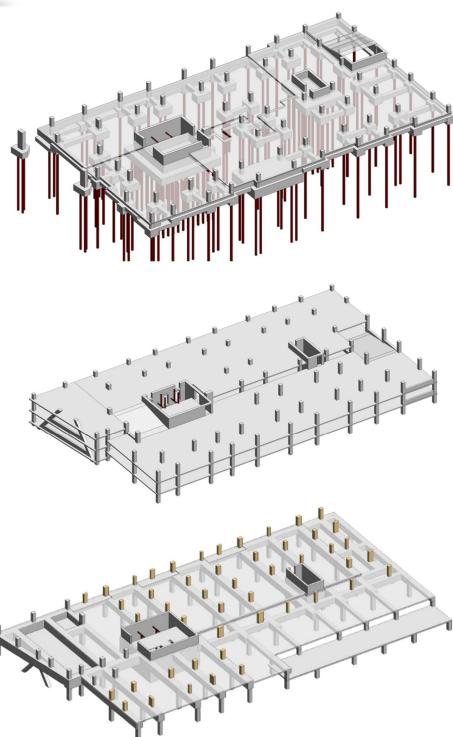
planta de fundaciones, planta de estacionamiento, planta de transferencia.
